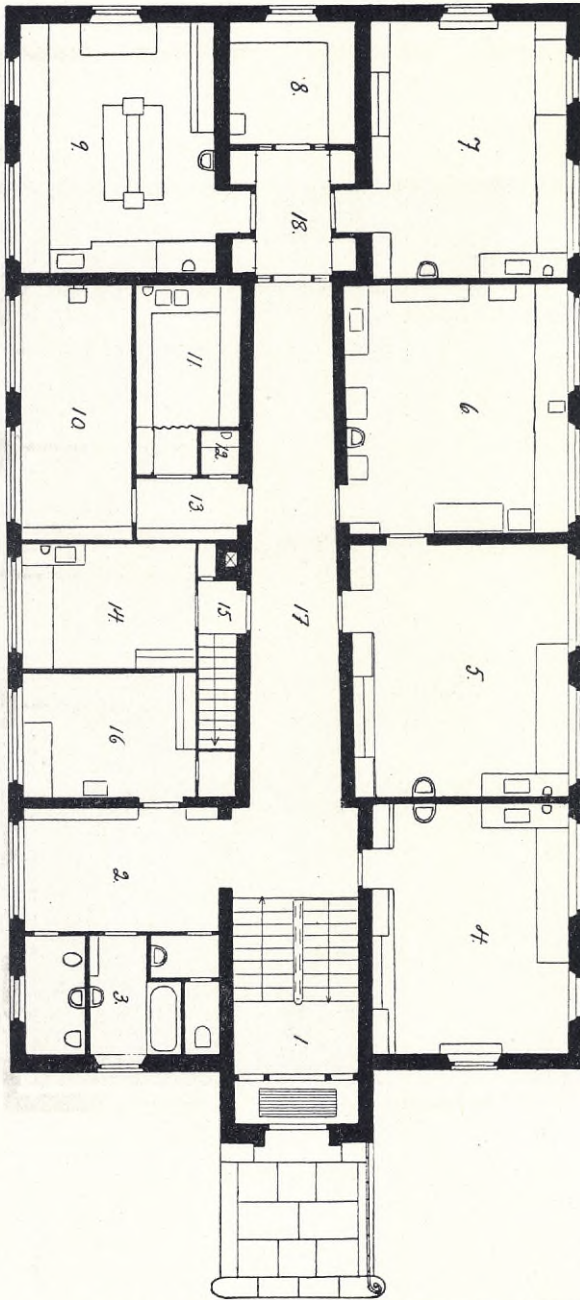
Plan av huvudvåningen. (Plan of the first floor.)
